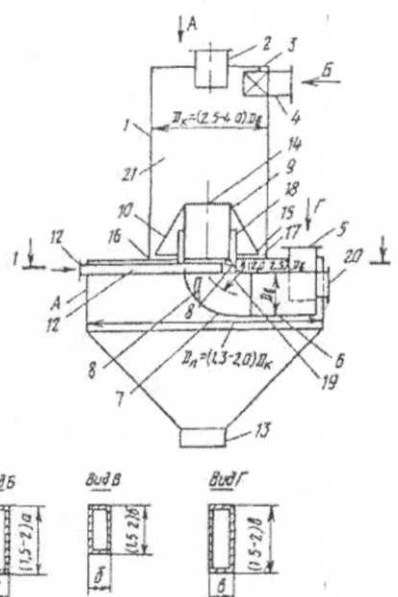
Вихревой пылеуловитель ВИП конструкции Азарова В.Н., Донченко Б. Т., Кошкарева С.А., Мартынова В.Н.: 1 – корпус аппарата; 2 – осевой вывод очищенного газа; 3 – ввод вторичного очищаемого потока газа; 4 – тангенциальный патрубок; 5 – тангенциальный патрубок ввода первичного очищаемого потока газа; 6 – прямой участок; 7 – криволинейное завихряющее колено; 8 – винтовой завихритель; 9 – окончательный прямой участок; 10 – отбойная конусная шайба; 11 – цилиндрический пылесборник; 12 – тангенциальный патрубок рециркуляционного вывода газа; 13 – патрубок выгрузки уловленной пыли; 14 – выходное отверстие; 15 – нижнее основание отбойной шайбы; 16 – нижний конец корпуса; 17 – кольцевой зазор; 18 – цилиндрический короб; 19 – радиус поворота оси криволинейного завихряющего колена; 20 – люк осмотра; 21 – сепарационное пространство
